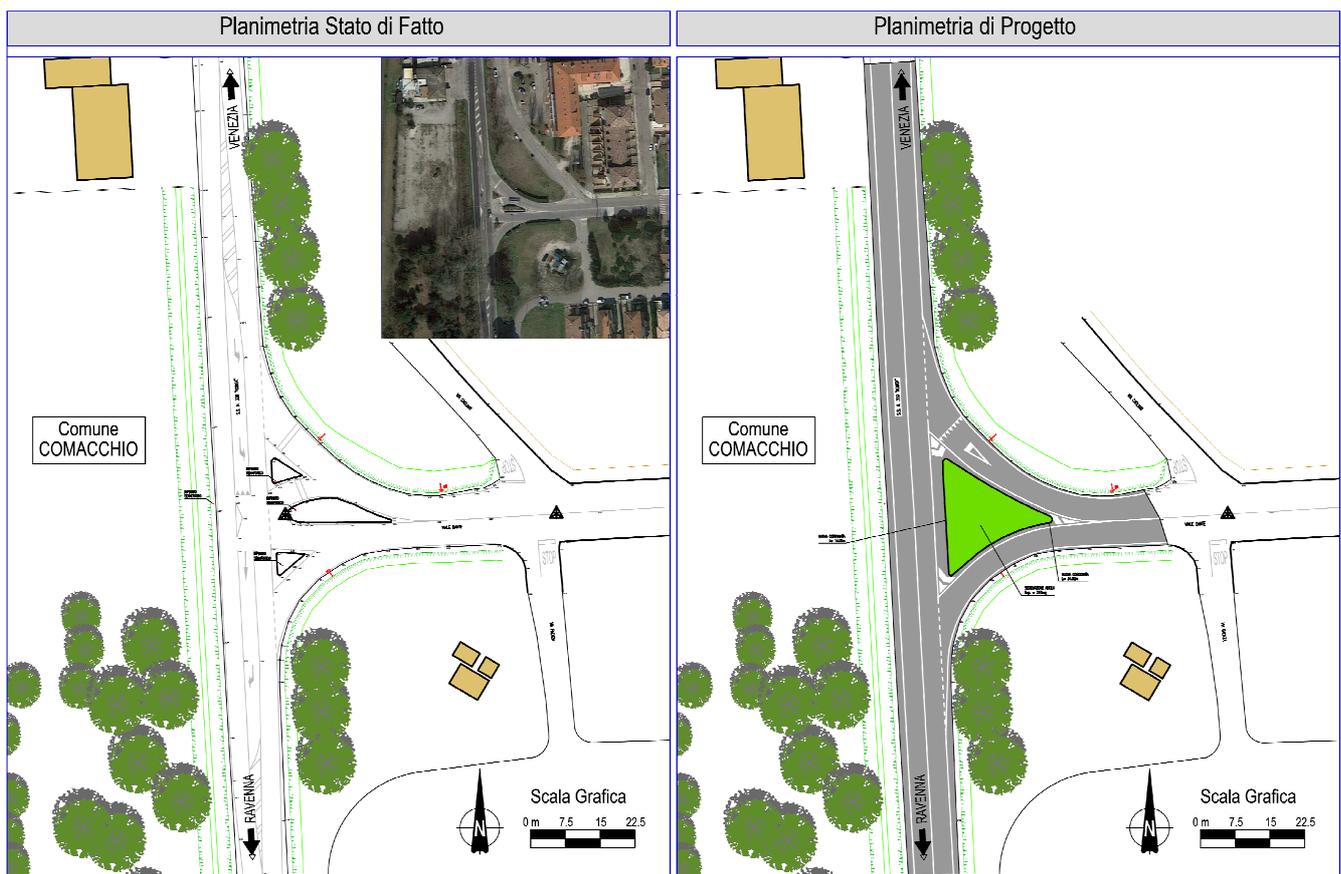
Intervento n°6 – Planimetria Stato di fatto - Progetto
